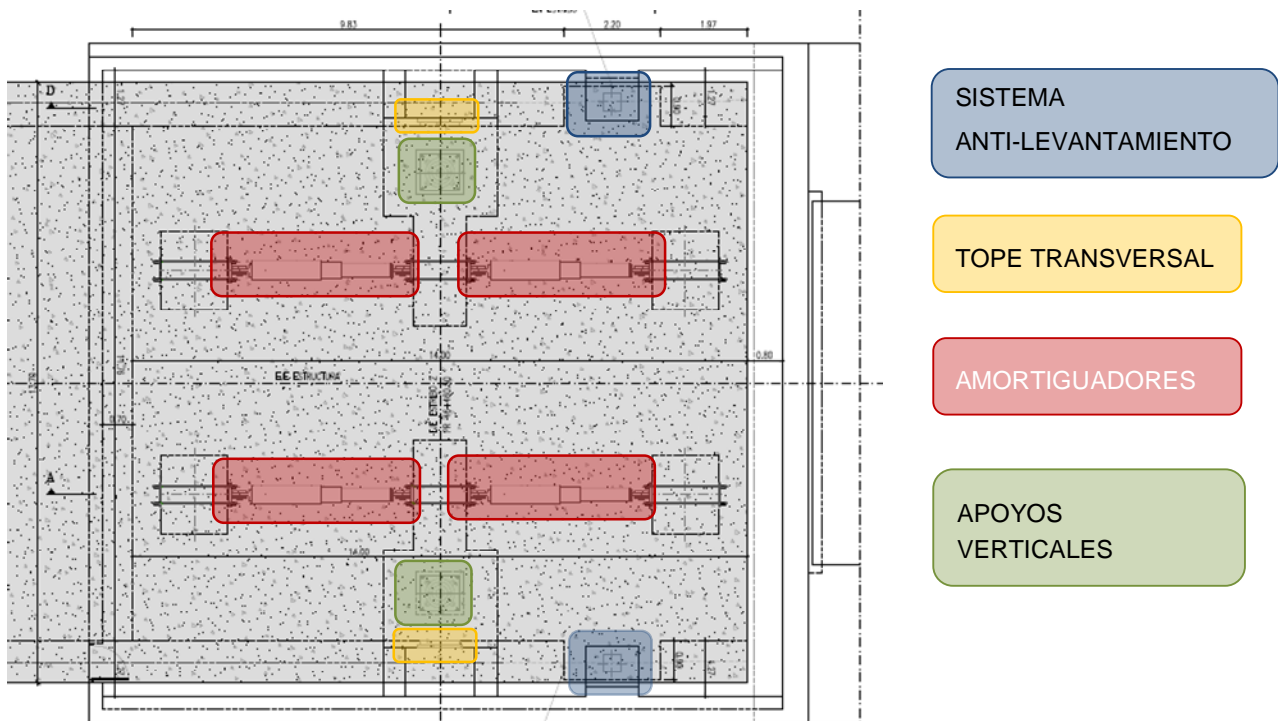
Planta condiciones de apoyo de tablero en estribo 2
